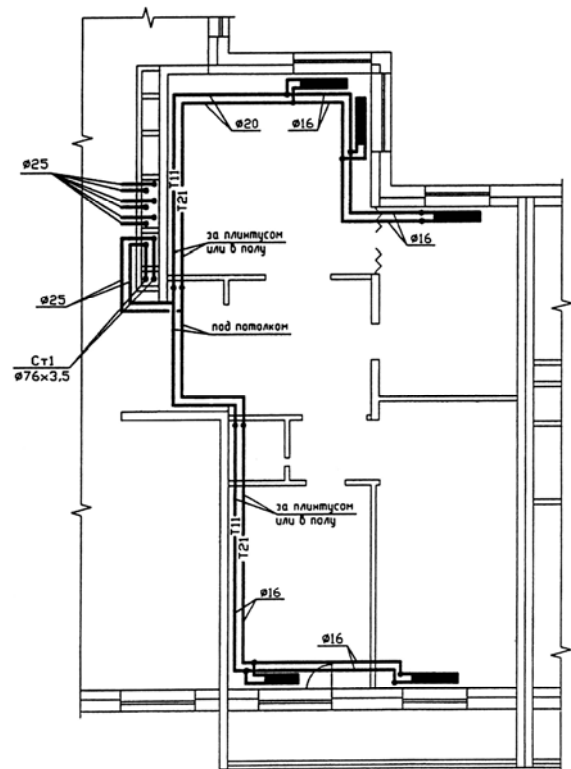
Система отопления с плинтусной разводкой теплопроводов по квартире
